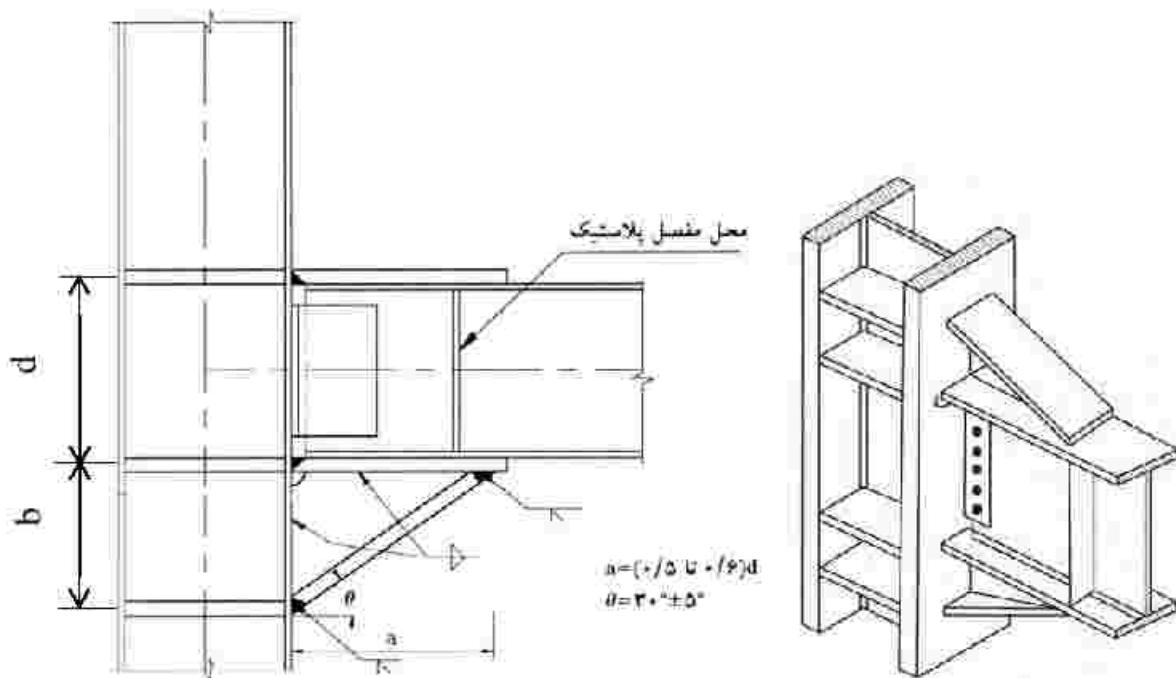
تقویت انصال یا ورق زیرسی و روسری مخاطع
